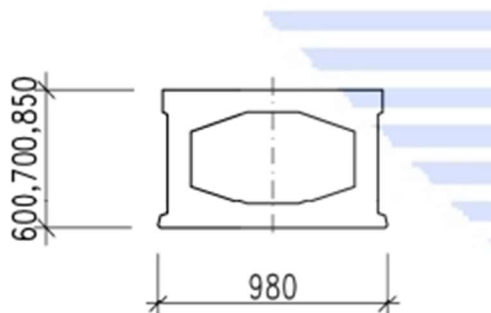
Provizorní pylony pro montáž konstrukce
